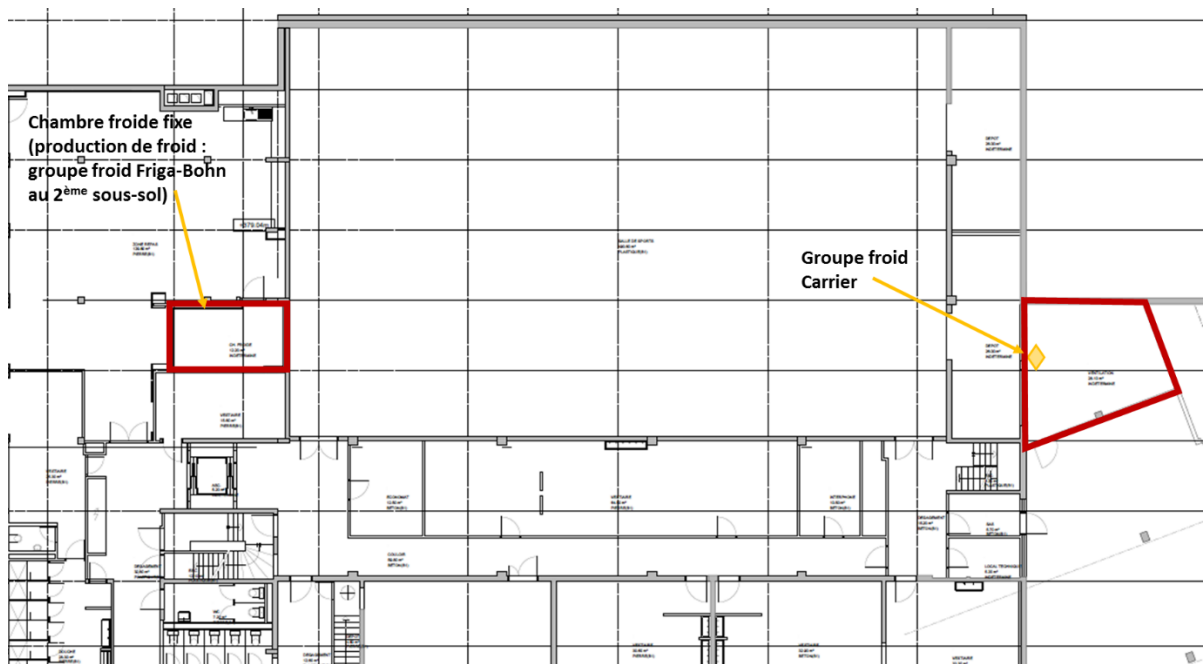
Localisation du groupe froid Carrier et de la chambre froide sur le plan du 1<sup>er</sup> sous-sol
